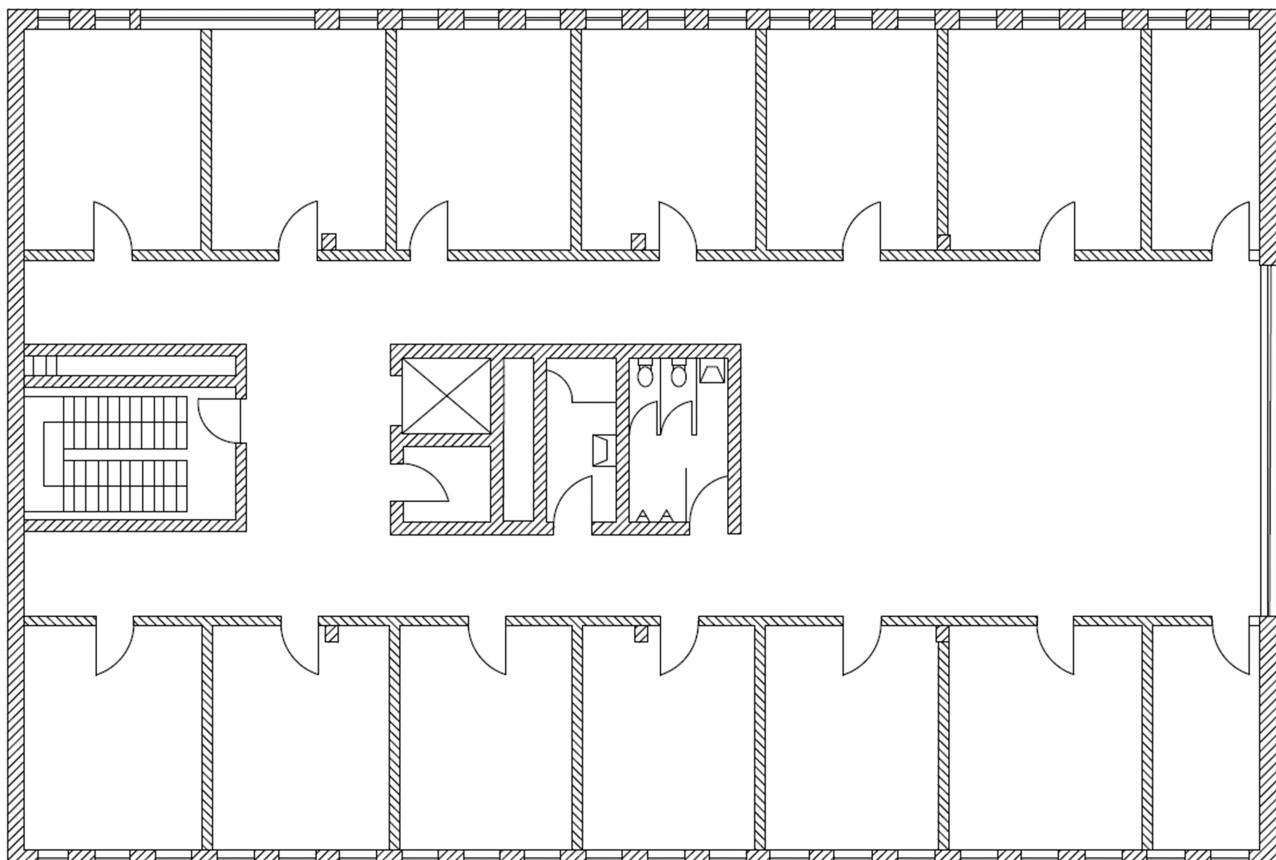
Grundriss VDI-Mustergebäude /
